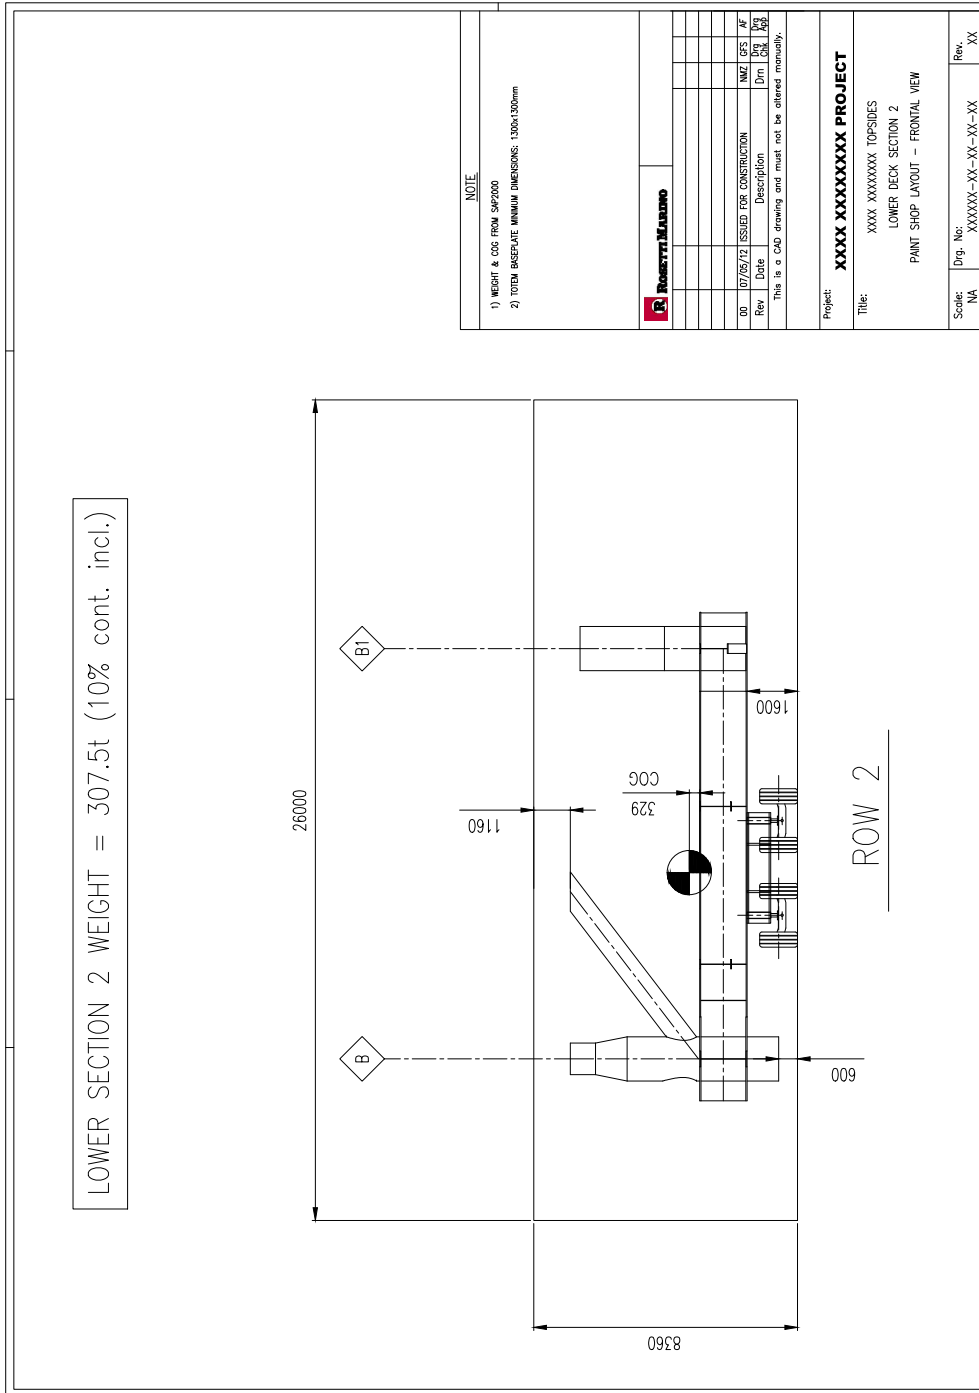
Lower level deck section 2 - Paint shop layout - frontal view
